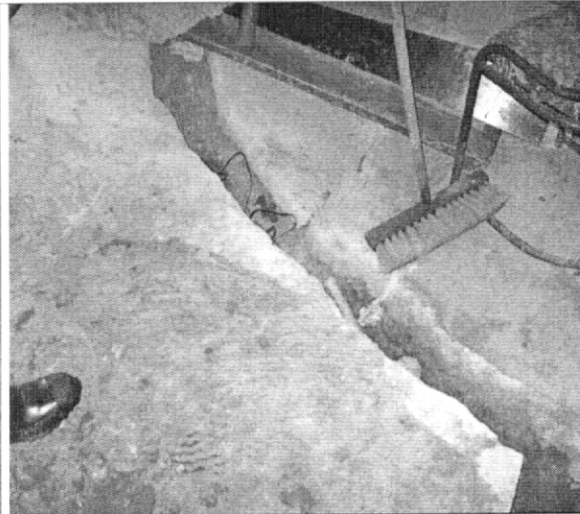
Grietas en el piso hasta de 10 centímetros de ancho y 30 centímetros de profundidad en el predio (Manzana 26 Lote 4) donde habita la familia de la Señora Gloria Amparo Arango.
